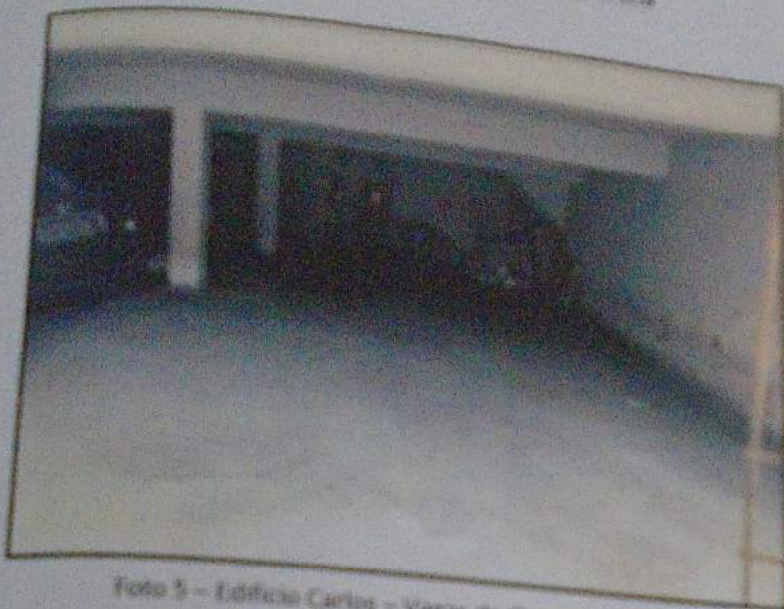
Edifício Carlos – Vagas de Garagem – Vista 2
